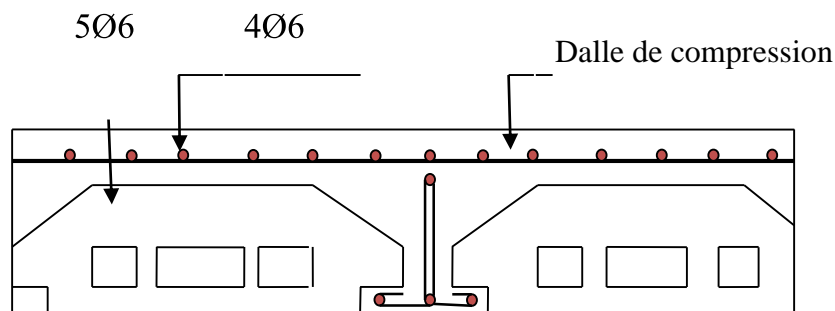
Schéma de ferrailage de la dalle de compression.
